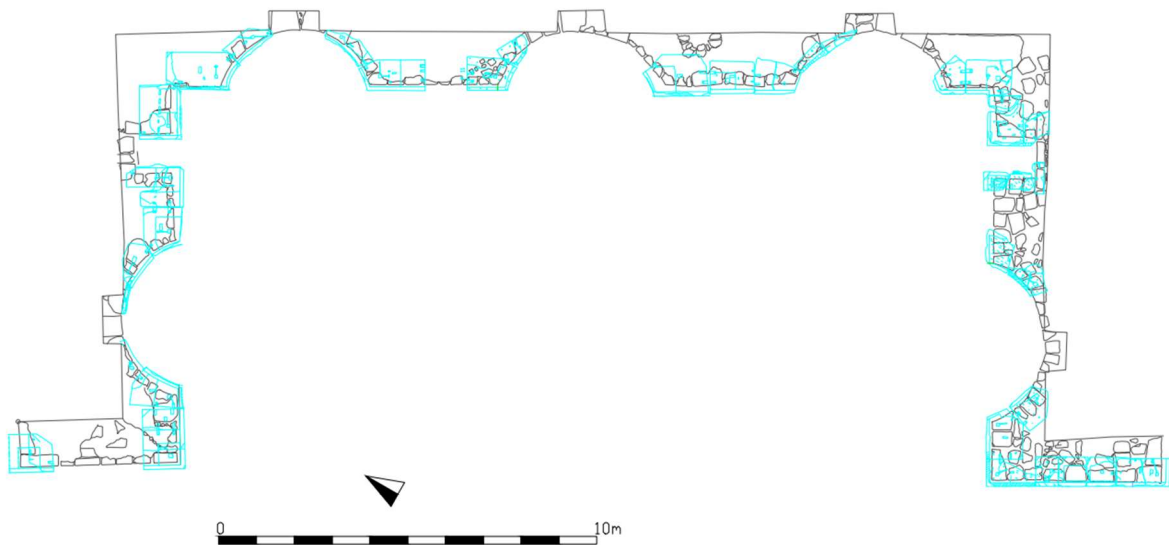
, planimetria con il posizionamento delle cornici del podio elaborazione di L. Campagna (Da Archivio MAIER).
